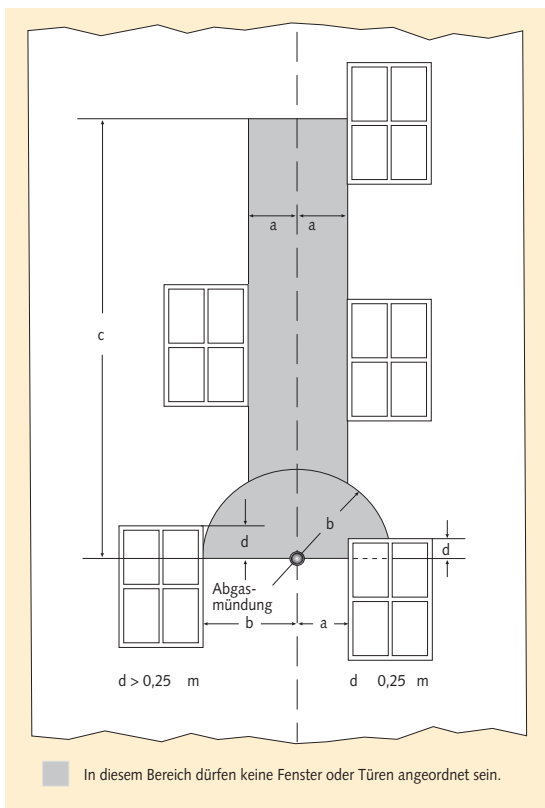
Mindestabstände einer einzelnen Abgasmündung zu Fenstern, die geöffnet werden können oder zu Fassadentüren bei glatten Fassaden
